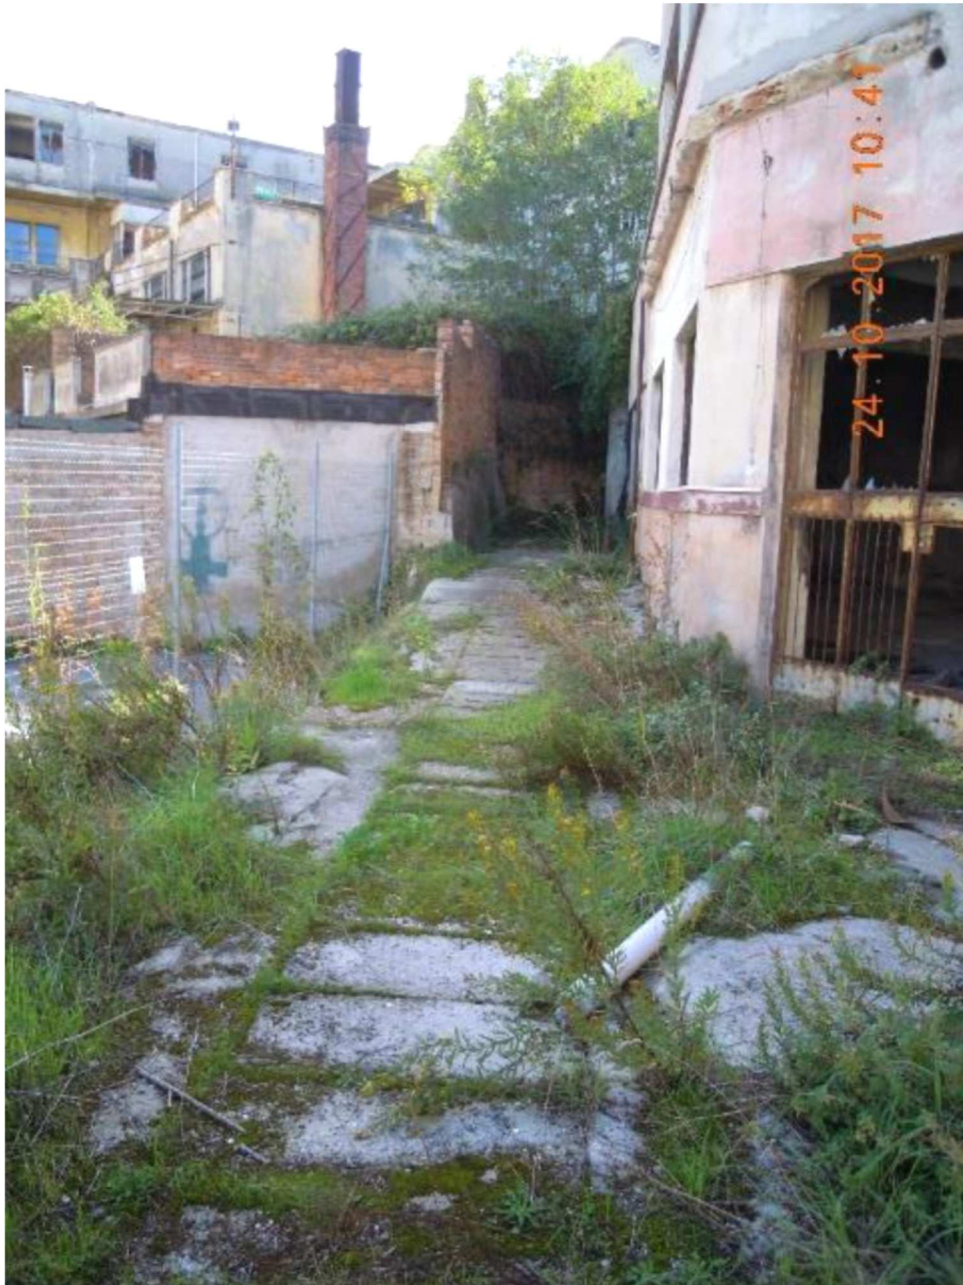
passaggio fognario sul piazzale antistante il fabbricato principale
